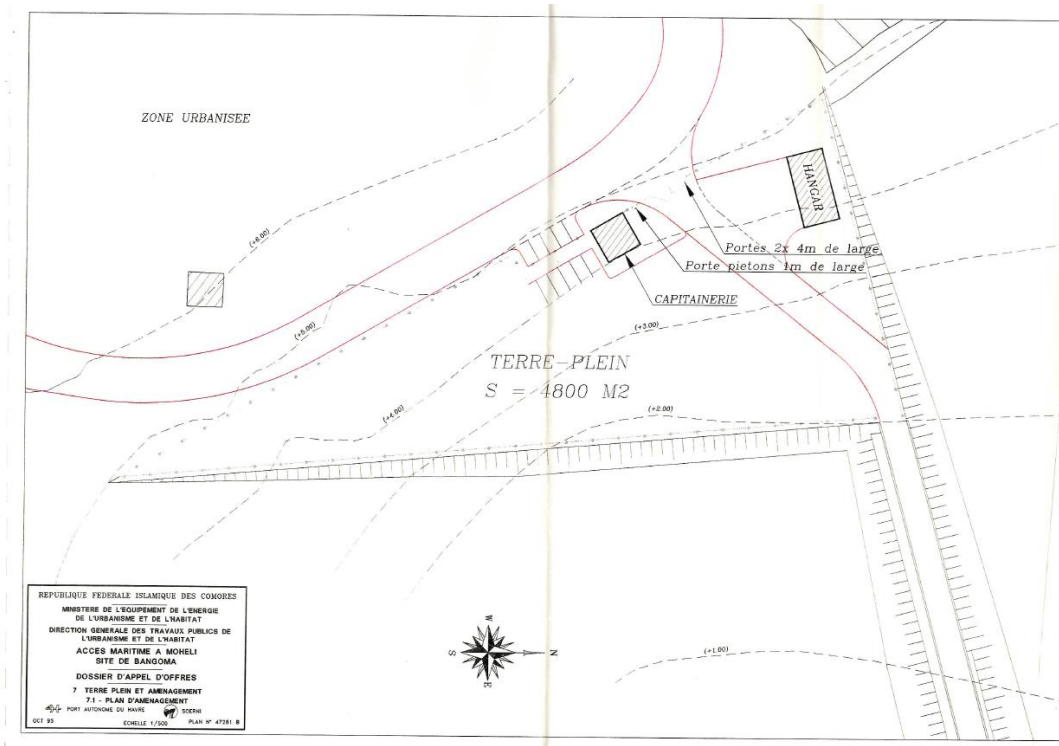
Plans issus du dossier d'appel d'offres [R31]
